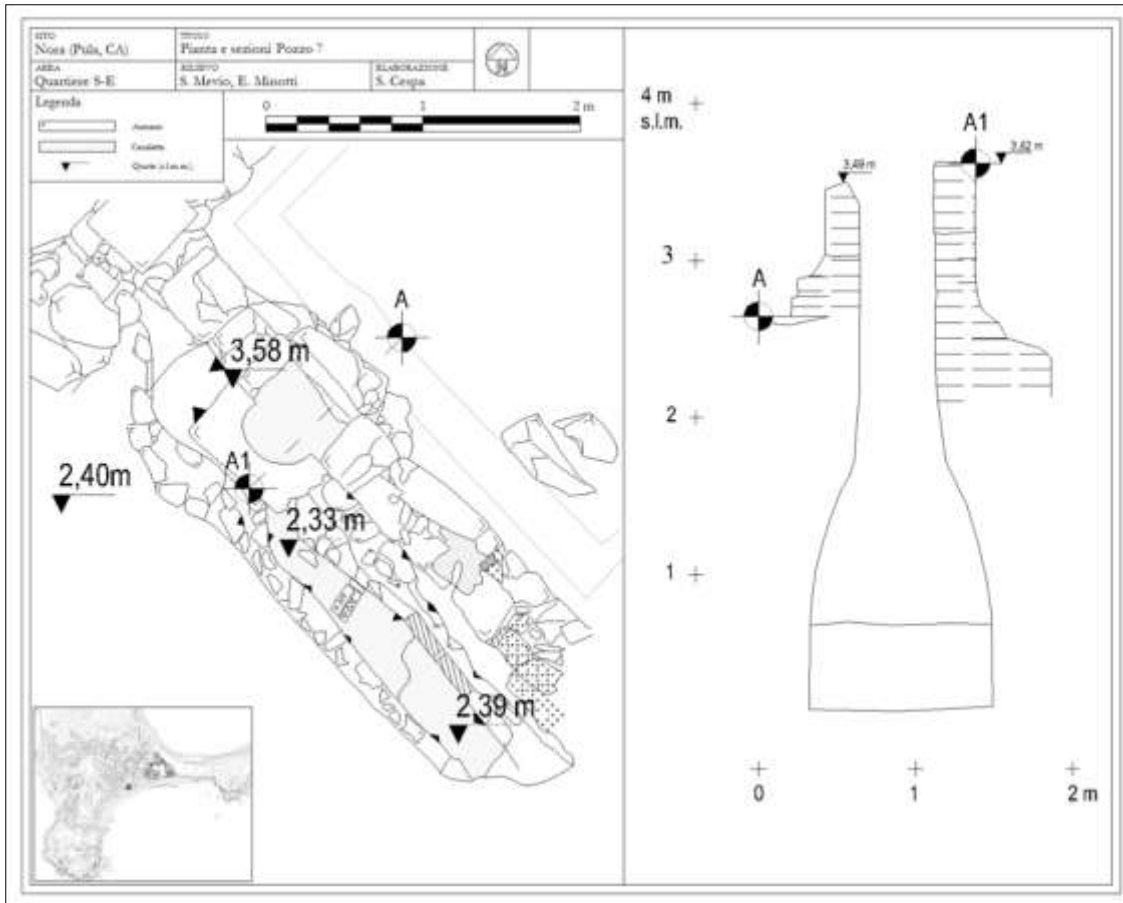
Pianta e sezione del pozzo 7 (elaborazione dell'autore).
